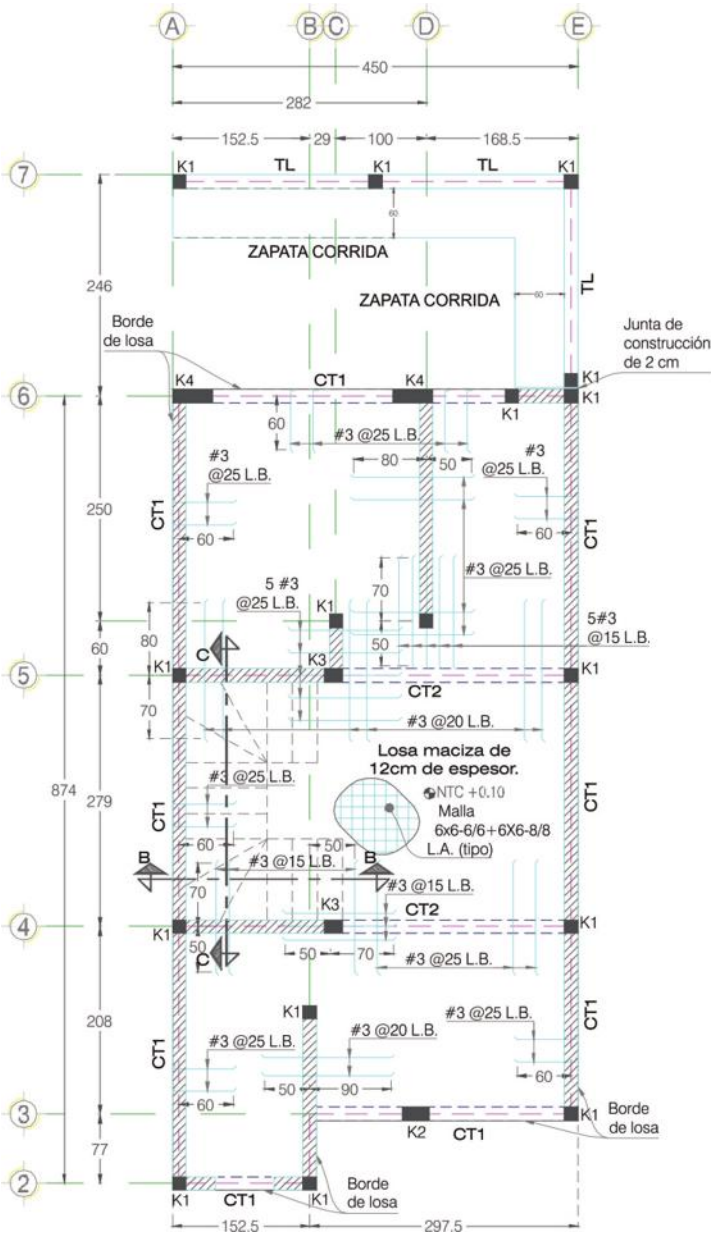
PLANTA DE CIMENTACIÓN (SAUCE).
